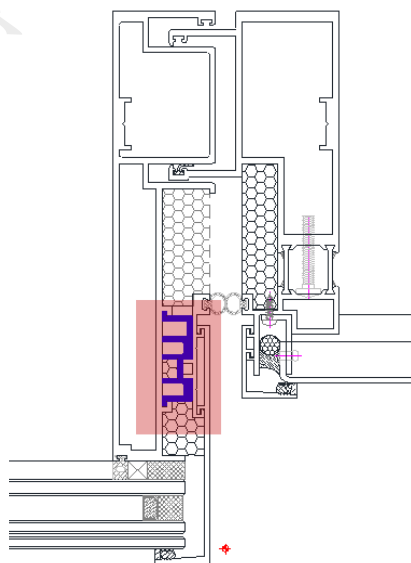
玻璃不在同一平面的幕墙构造示意图
